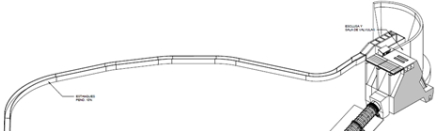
Presa JC – Esquema del proyecto en planta (Fuente: Elaboración propia)
